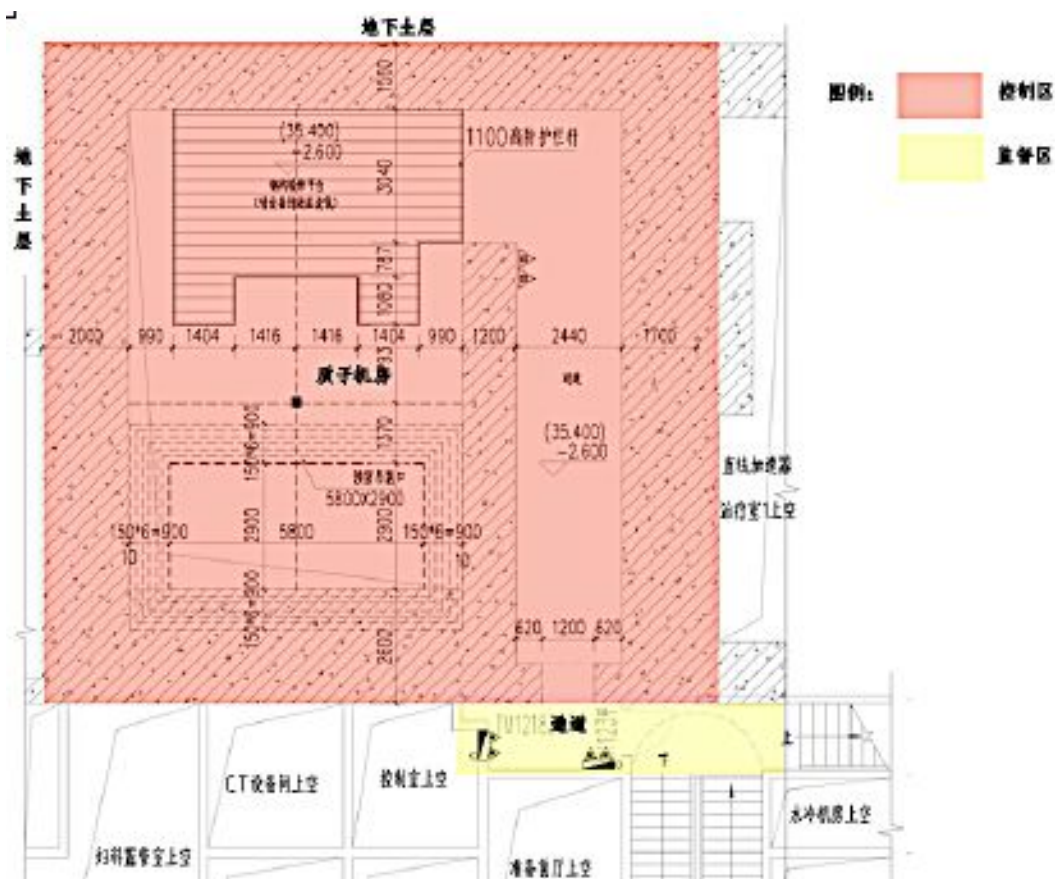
质子治疗机房辐射工作场所分区平面图（检修层）
